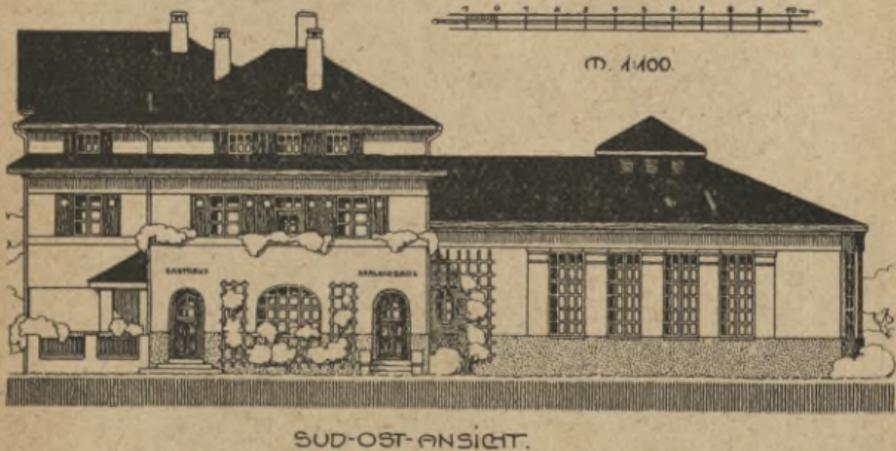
Wohnhausgruppe mit gewerblichen Anlagen.
